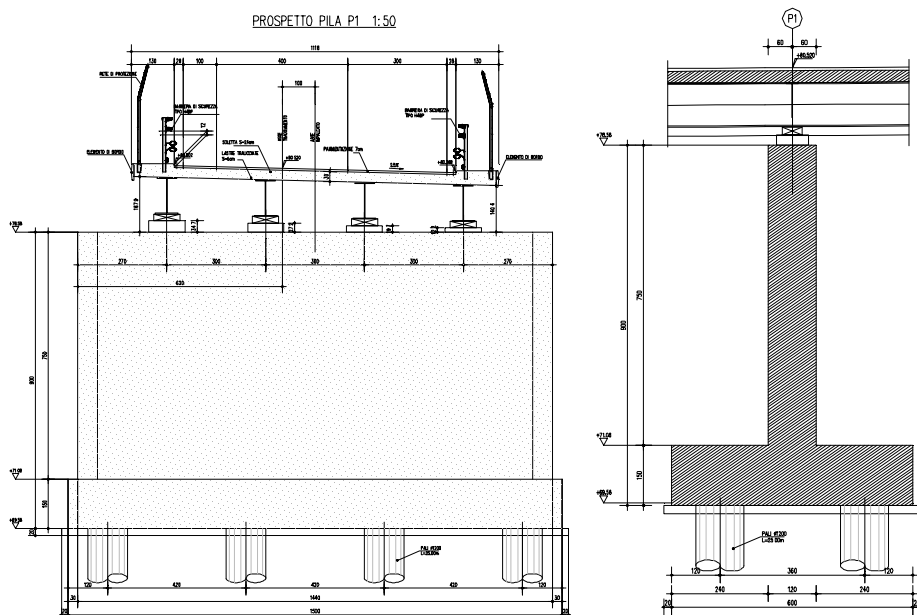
Pila P1 - Sezione in retto impalcato e sezione trasversale
